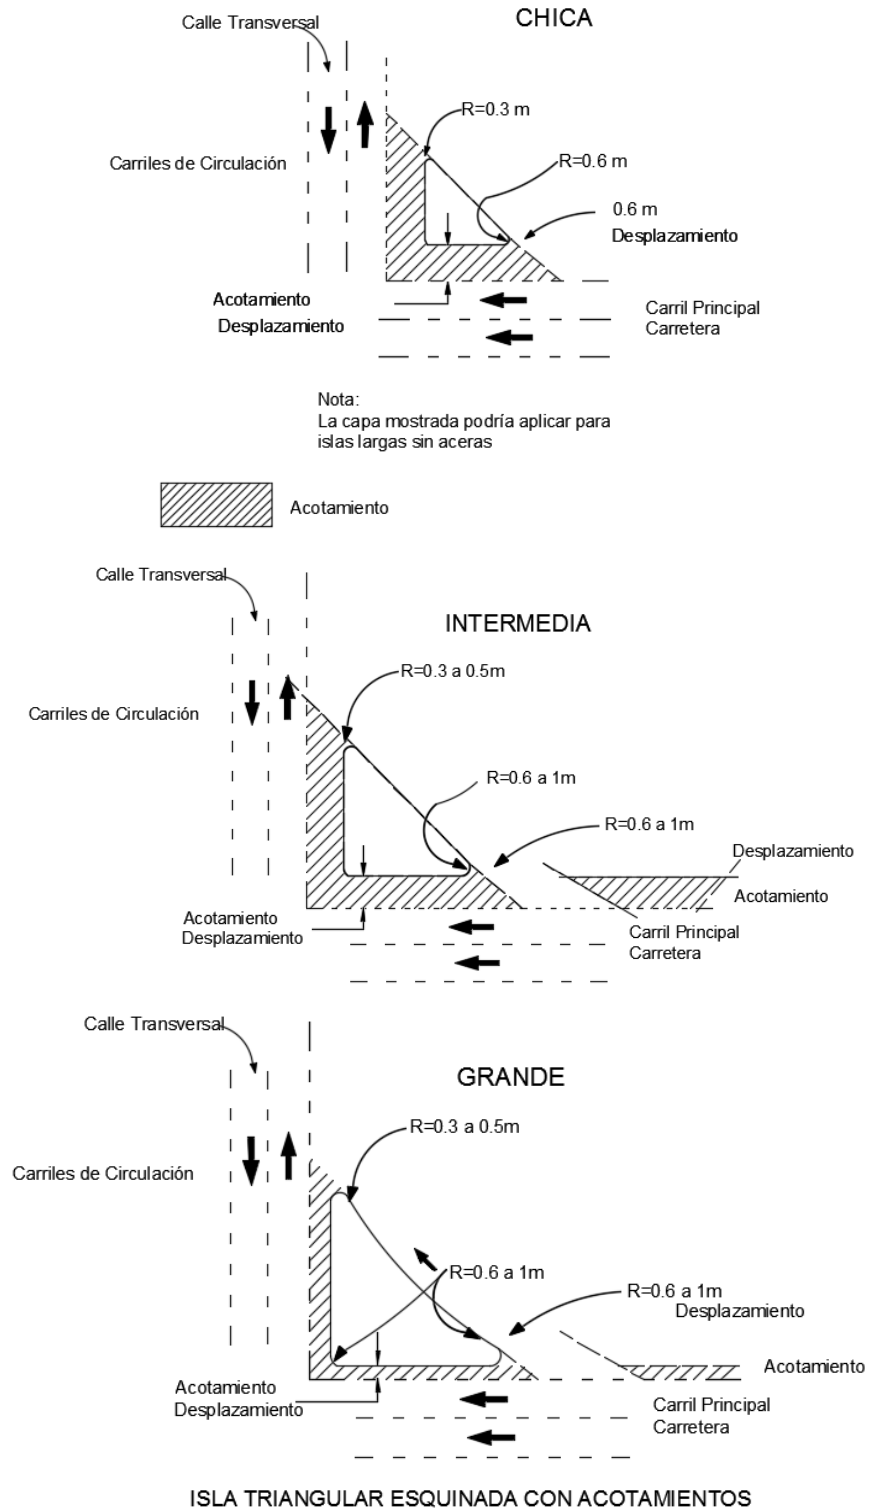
Detalles de diferentes proyectos de isletas en esquina para carriles para dar vuelta (sección transversal rural en el acceso)
